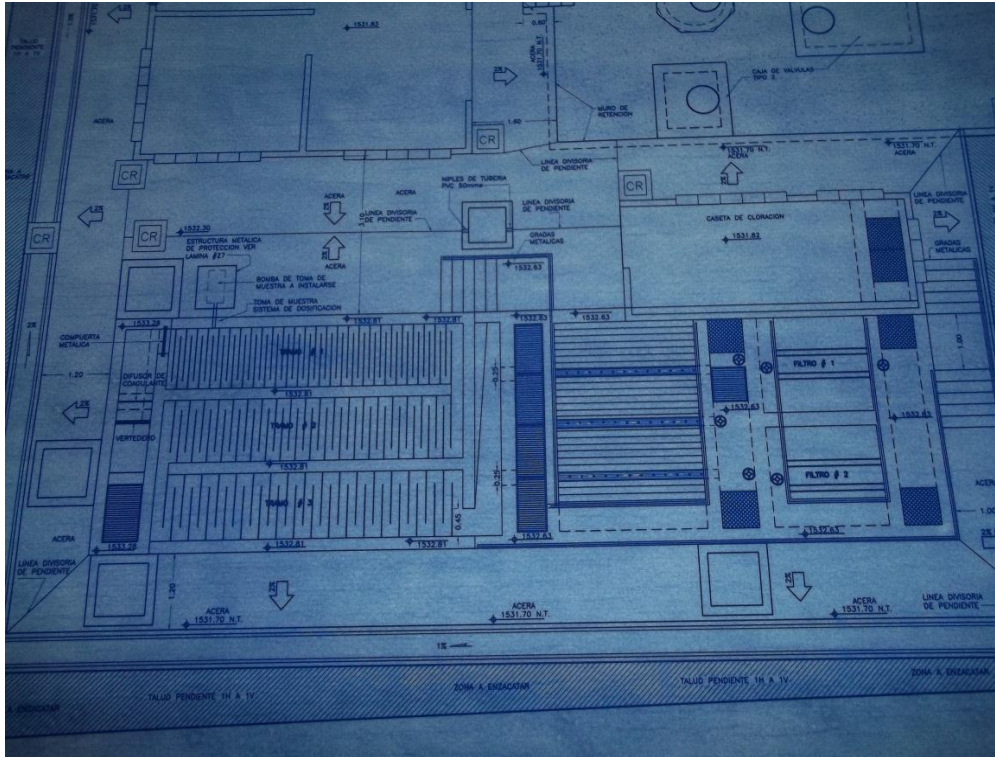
Sistema de filtración rápida El Tigre, Vista en planta en plano realizado por AyA.
